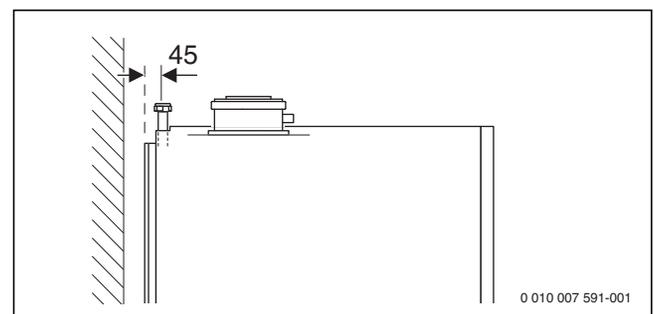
Anschlussmaße des Zubehörs Anschluss-Set solare Heizungsunterstützung SHU (Maße in mm)
